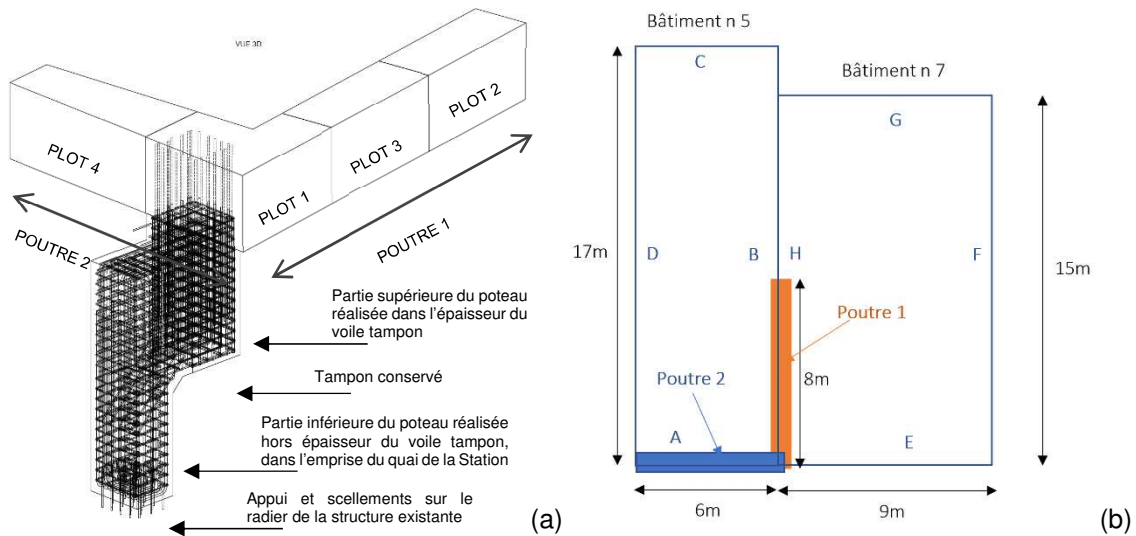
Décomposition par plots de la poutre RSO (a) et vue en plan de la poutre RSO avec poutre RSO 1 et poutre RSO 2 (b)
